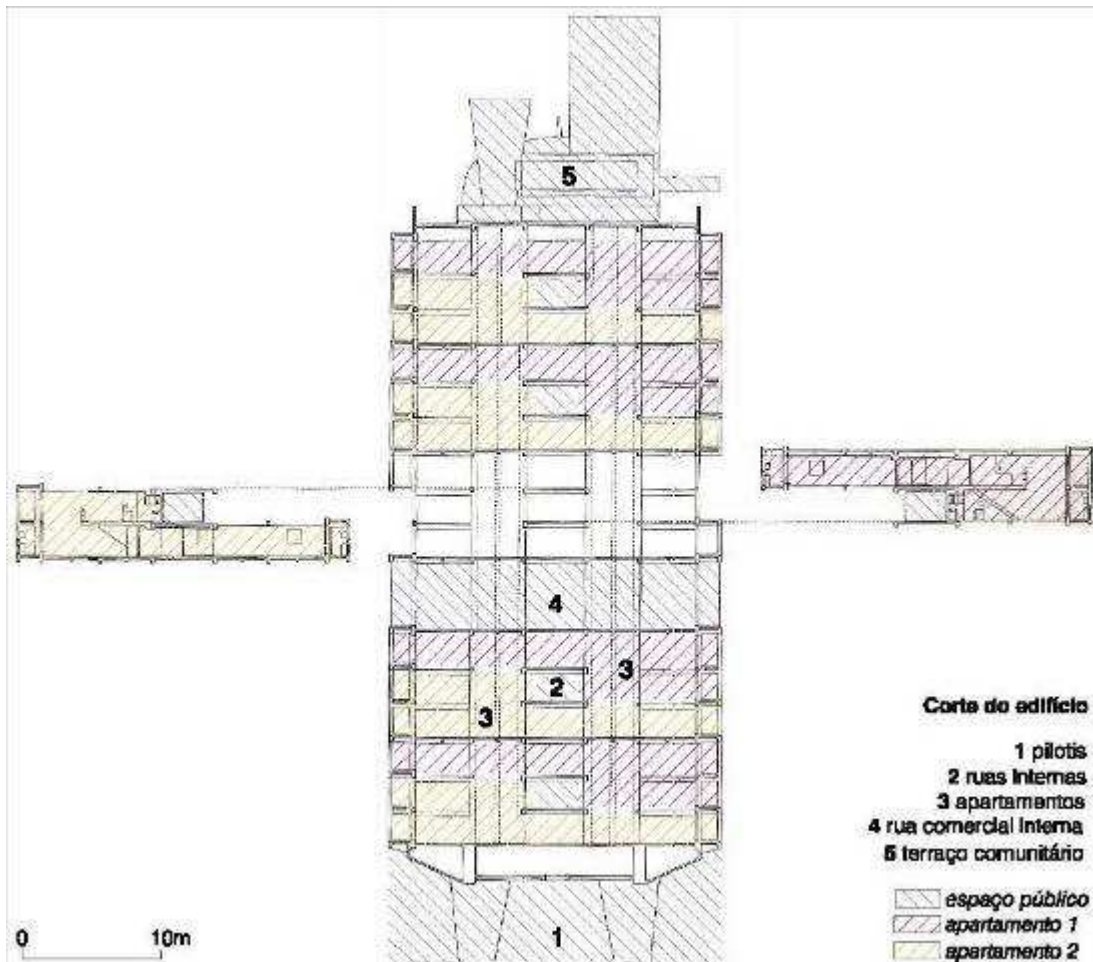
Corte transversal: disposição dos apartamentos e das ruas internas.
